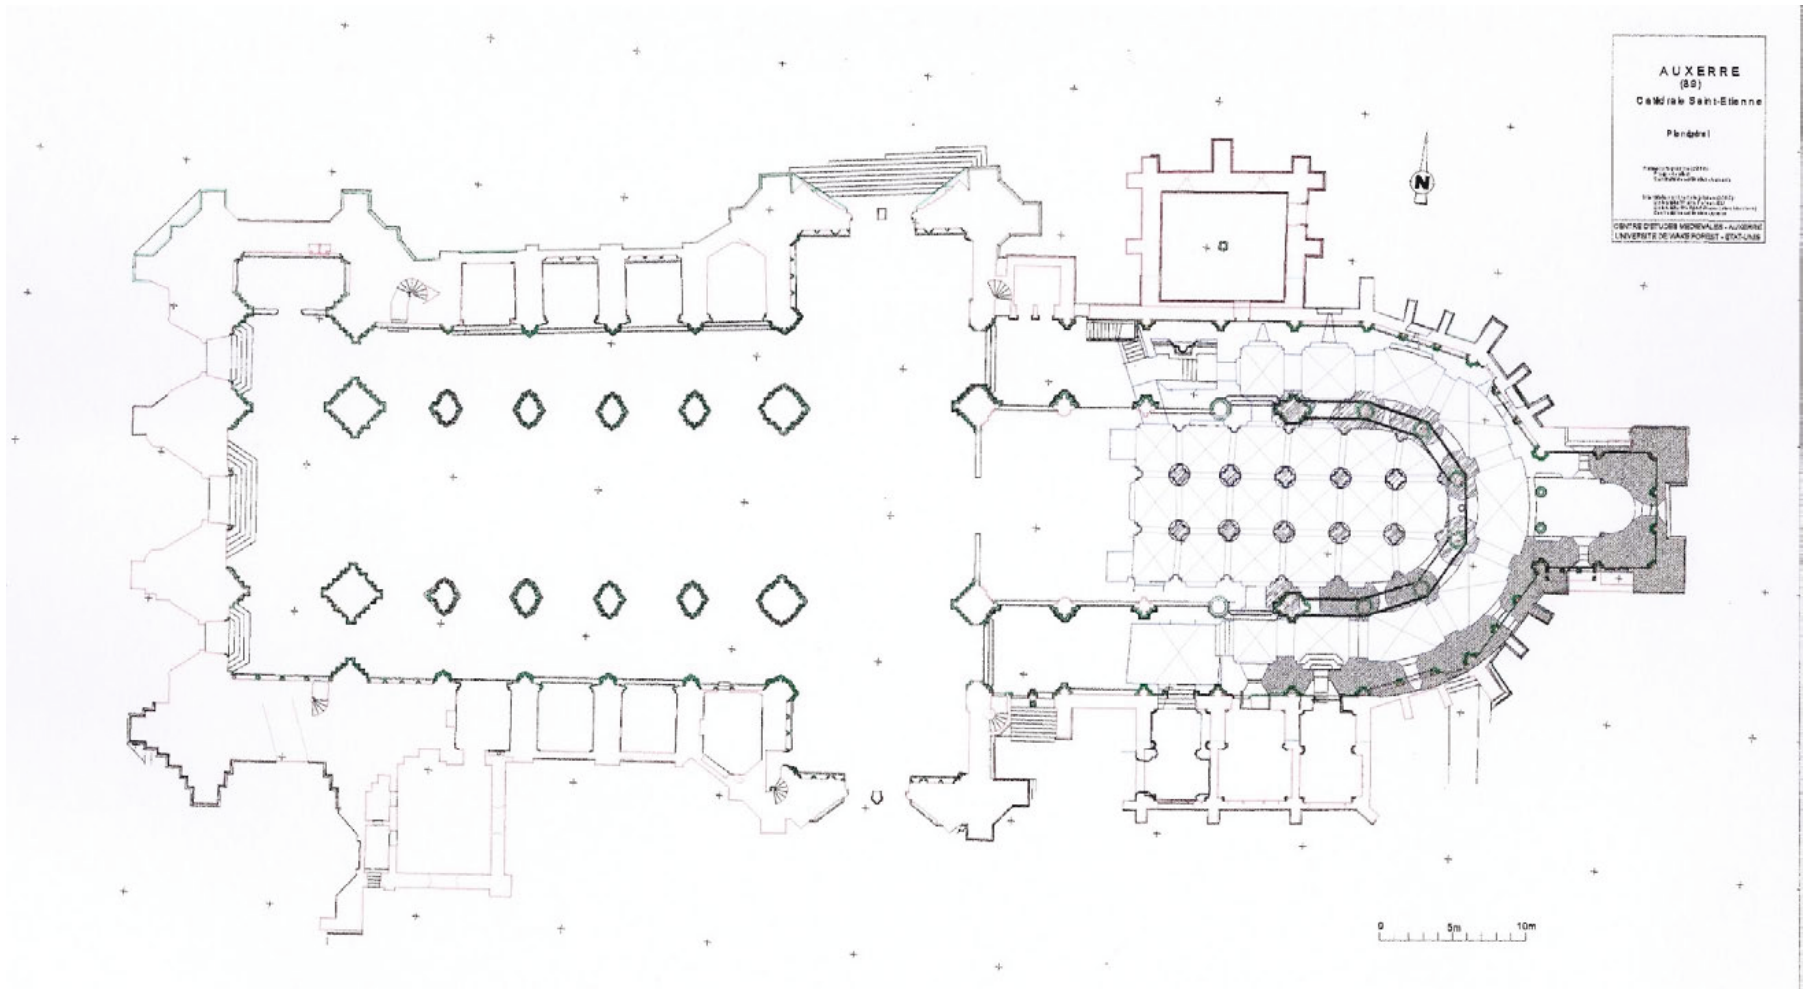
Grundriss der Krypta und darüberliegende Chormauern
